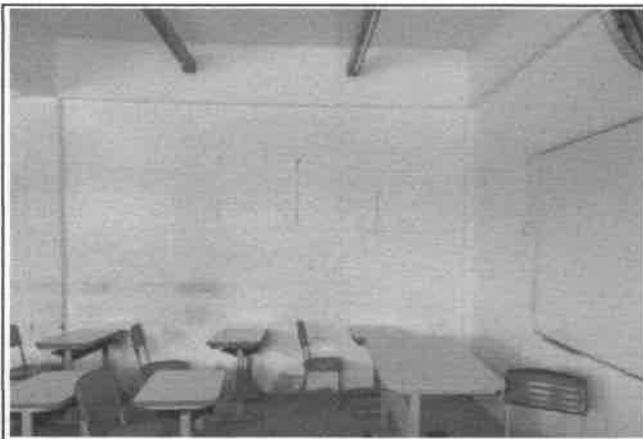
REVESTIR PAREDES SALAS DE AULA BLOCO ANEXO
